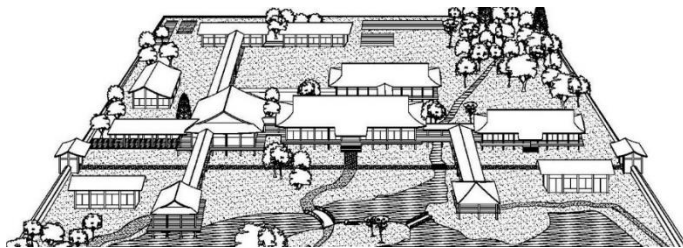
Fachada de la vivienda muestra la extensión de los suelos a modo de verandas elevadas y los techos con aleros de igual manera.
